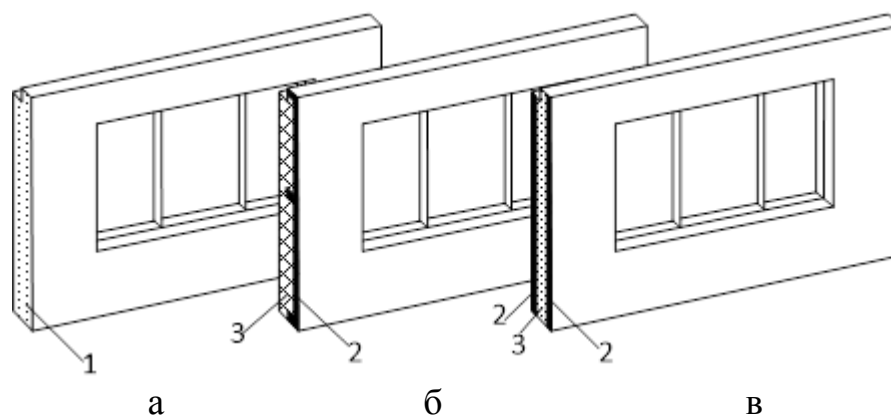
Основные типы конструкций панелей наружных стен гражданских зданий: а – однослойная армированная, б – двухслойная, в – трехслойная; 1 – армированный бетон, имеющий необходимые показатели прочности и теплоизоляции, 2 – железобетонная тонкая плита из высокомарочного бетона, 3 – теплоизоляционный материал (минеральная вата, пеностекло, пенобетон, пенополистирол и др.)
